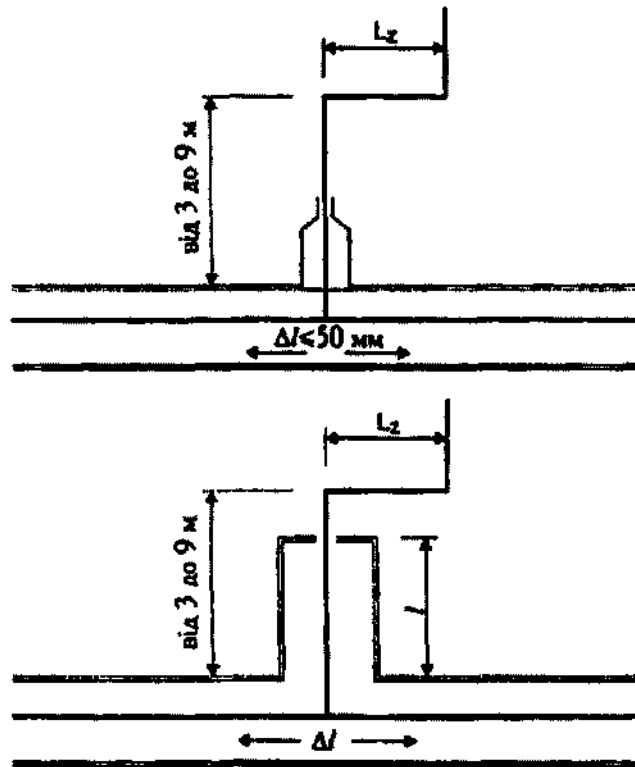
Варіанти поєднання трубопроводів СТ/ПЕ з трубопроводами канального прокладання
